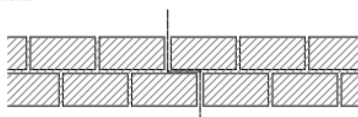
Junta de movimiento con solape. Esquema en planta
